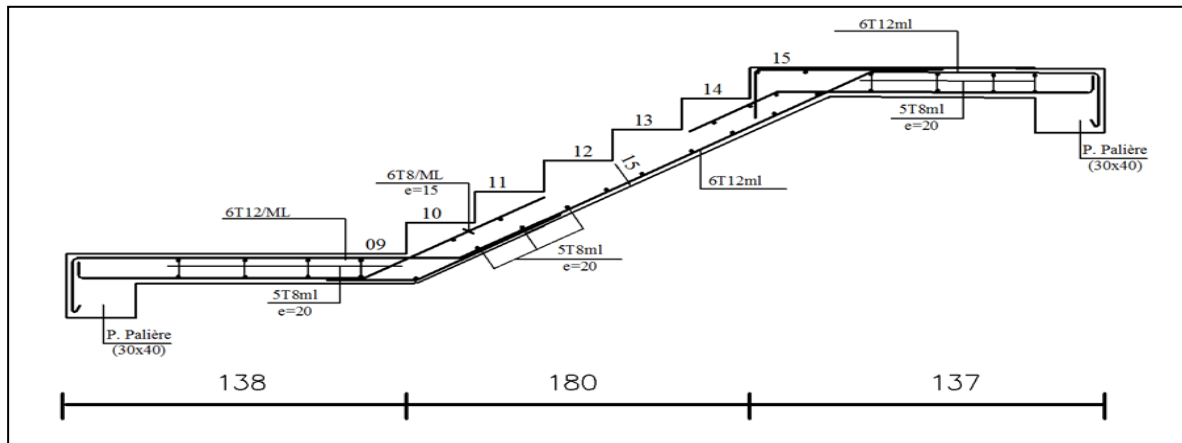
Schéma de ferrailage de l'escalier (RDC) Typ2.
